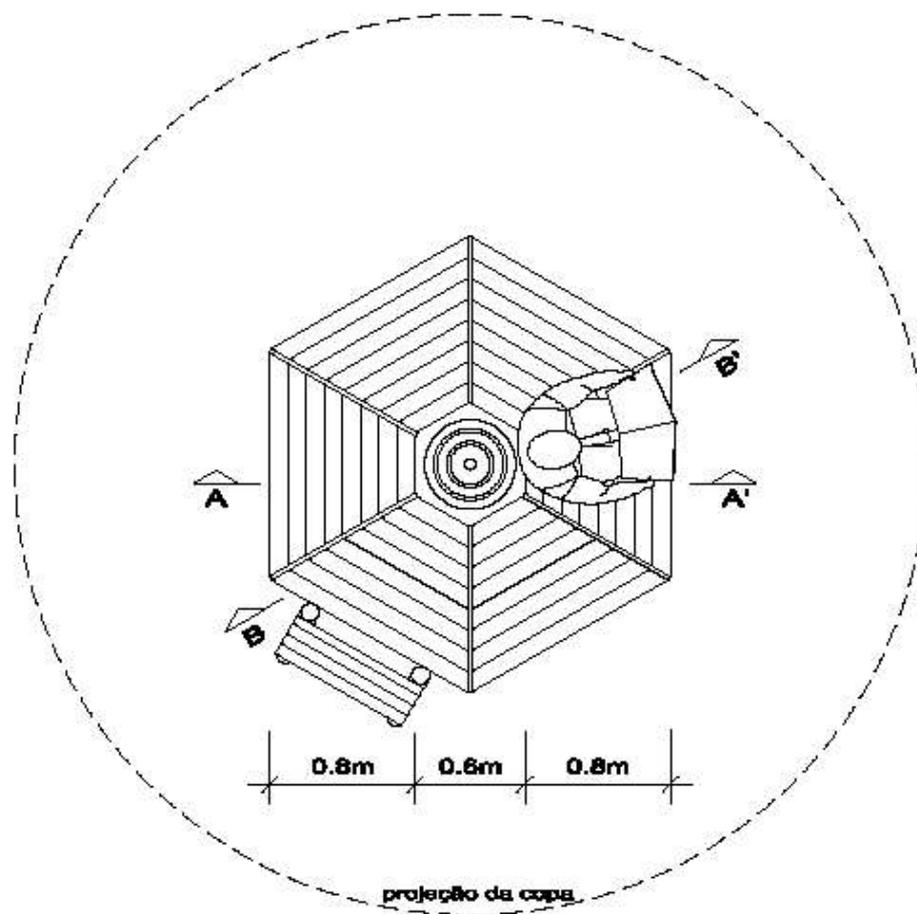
Planta baixa da plataforma proposta ao HEPA.
